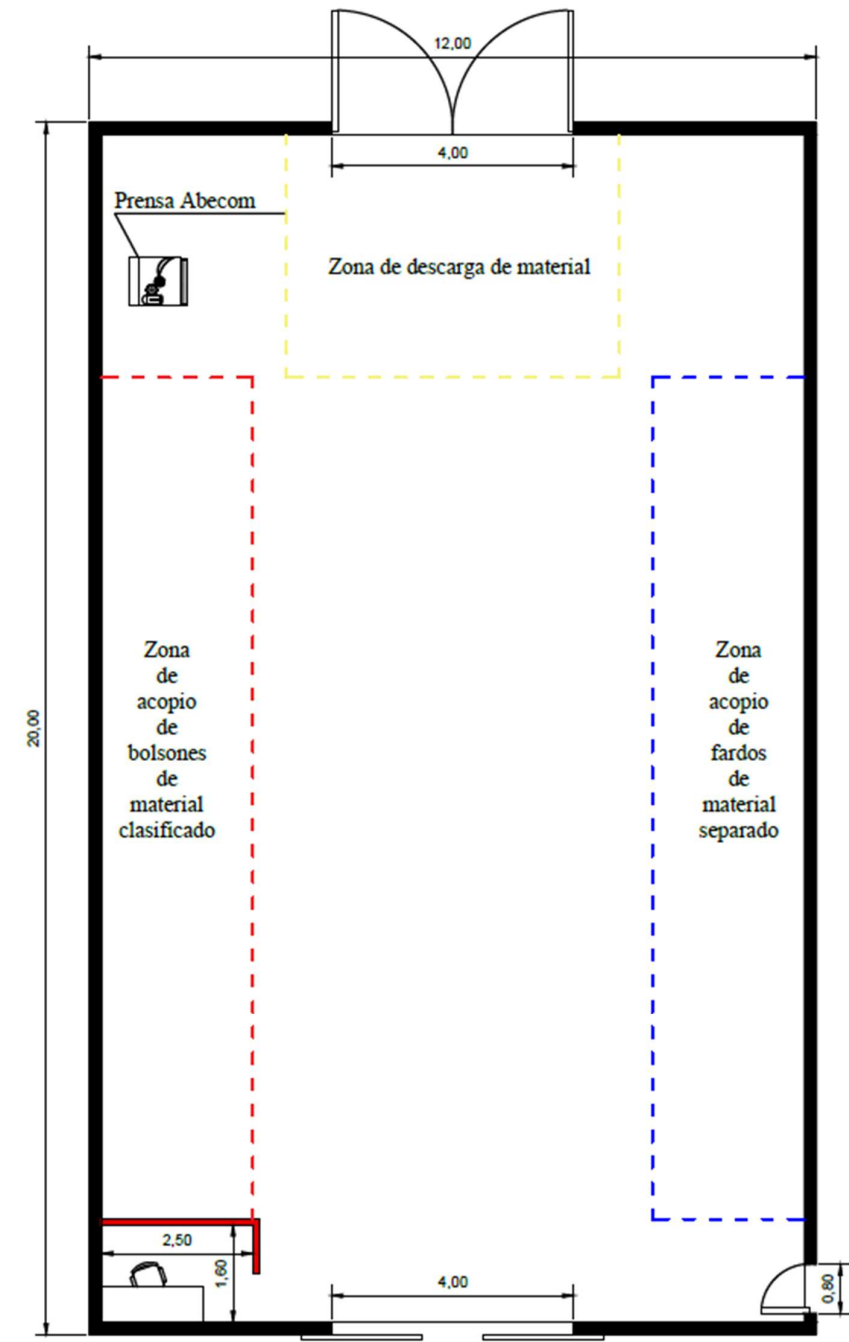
| Layout de la planta recicladora actual, en el galpón en alquiler donde trabajan 3 personas.
